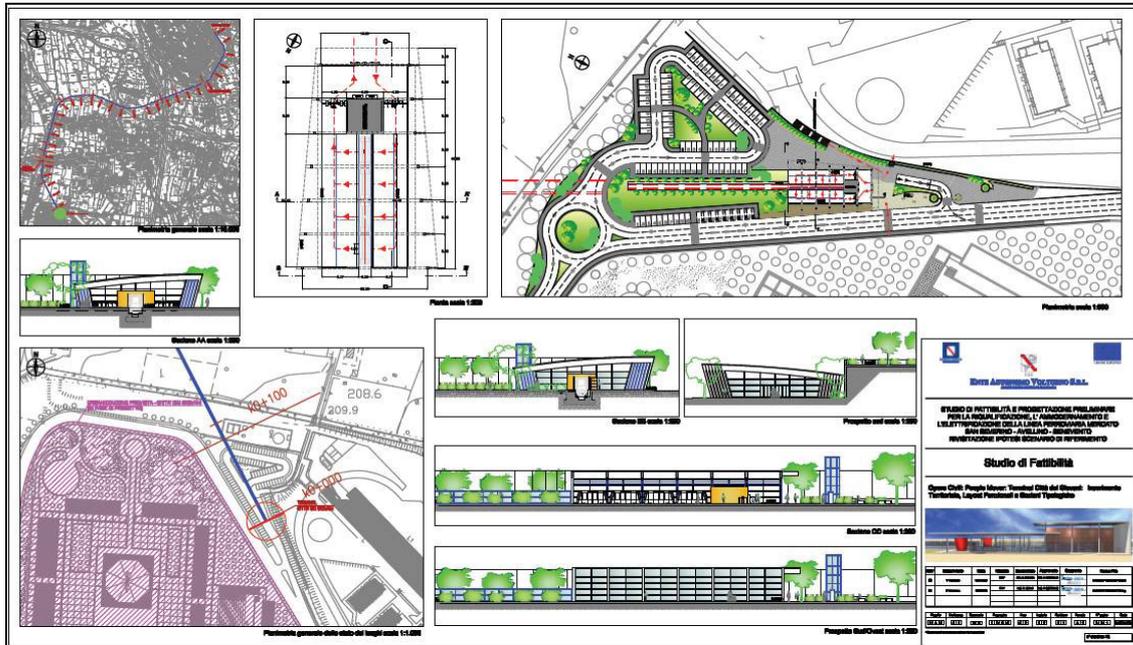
Sistema di trasporto “People mover” - Stazione “Città dei Giovani” tratto dallo Studio di Fattibilità redatto dall’Ente Autonomo Volturmo s.r.l.
